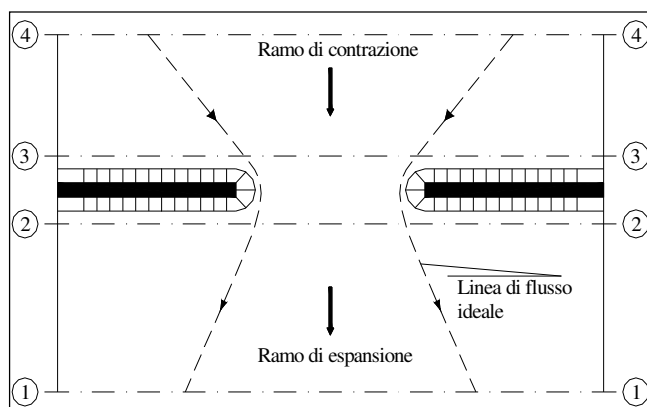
“Pianta schematica di un attraversamento fluviale”
